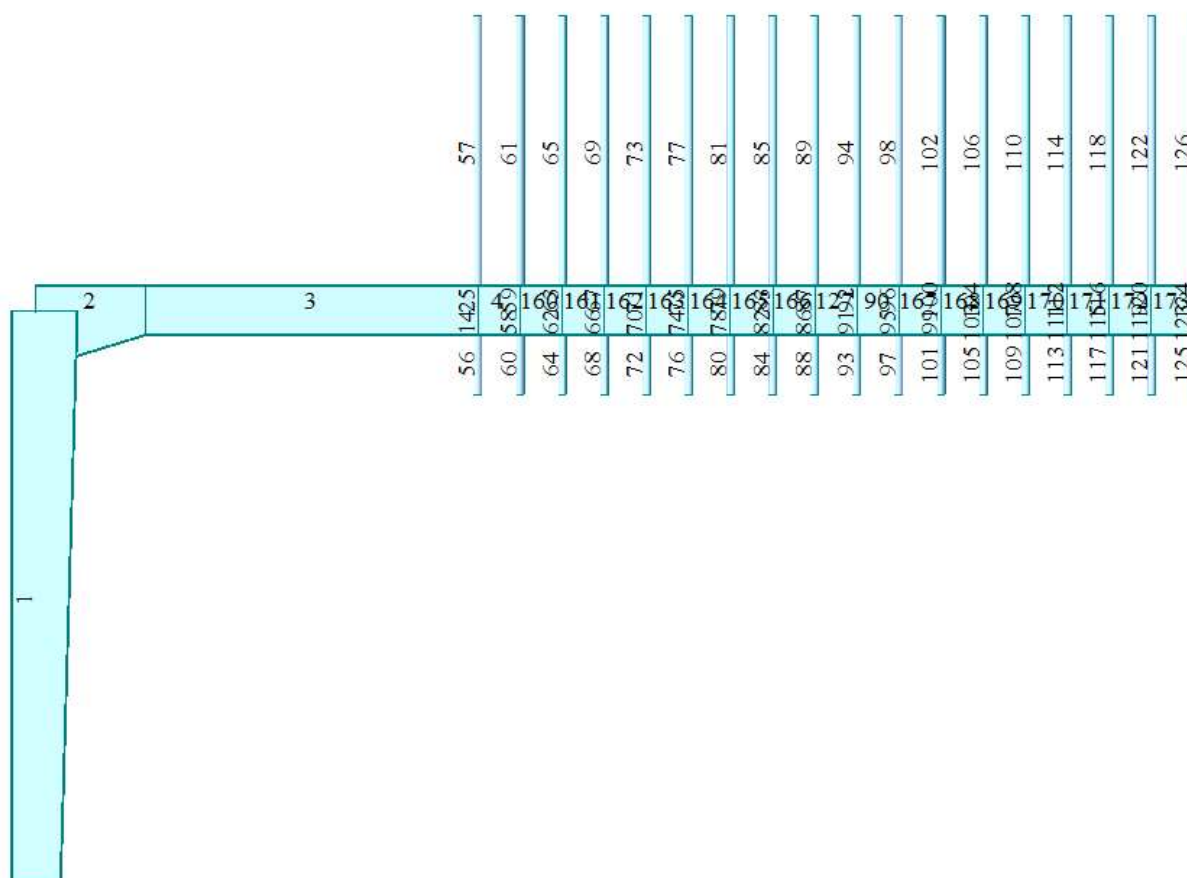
Modello di calcolo FEM - numerazione degli elementi
